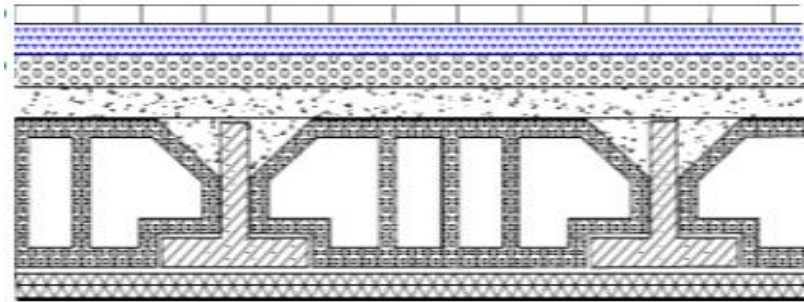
Coupe verticale du plancher courant à corps creux.
